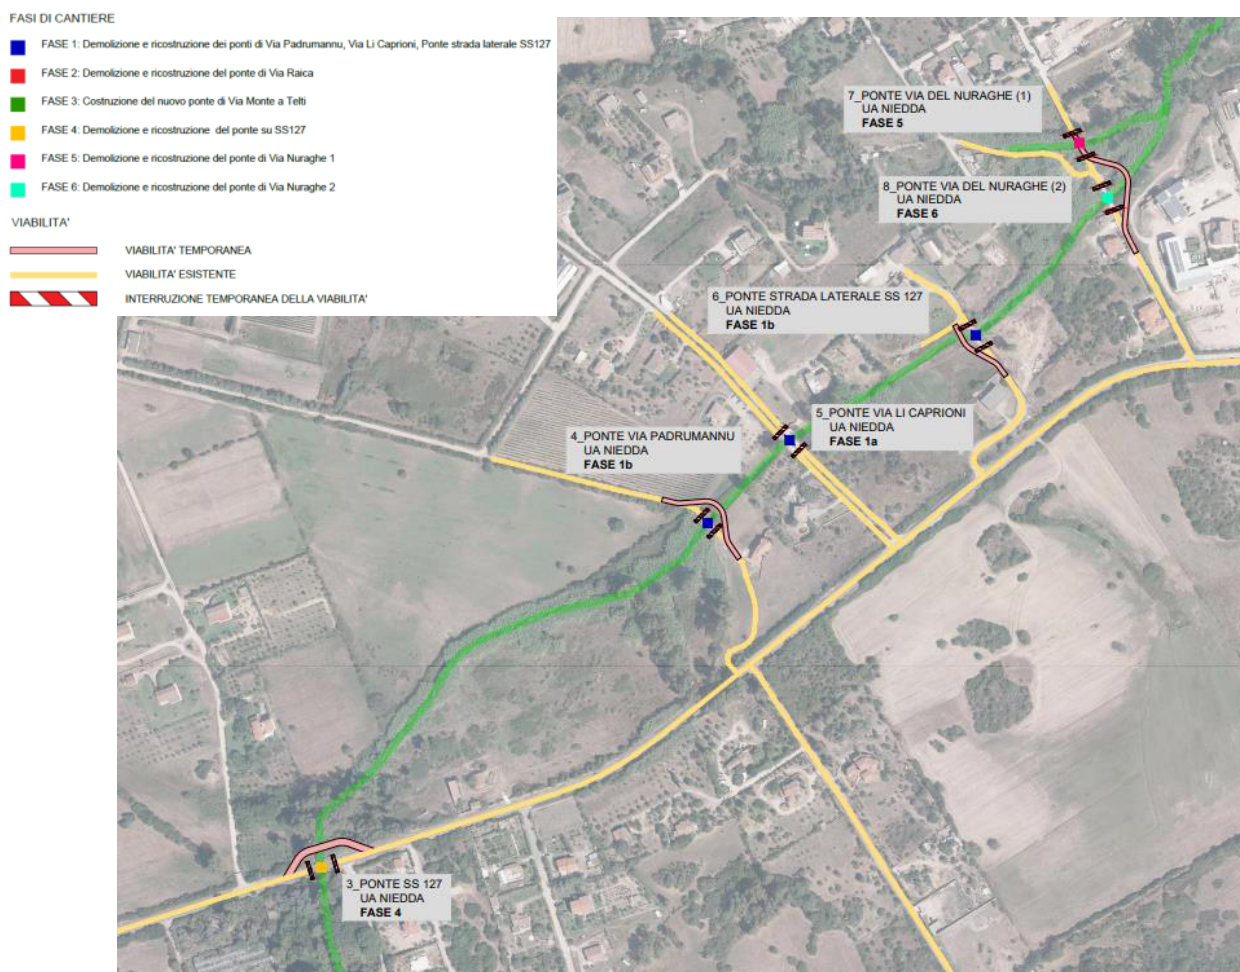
Attraversamenti cantiere 2.4 – Rio Ua Niedda
